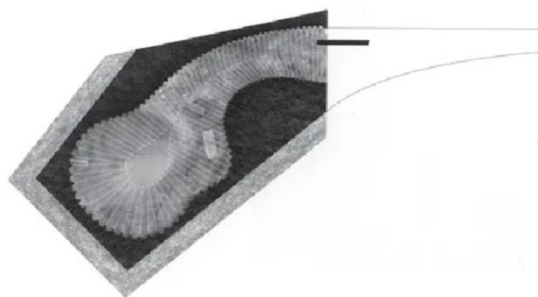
Capela Bruder Klaus. Planta Baixa. Wachendorf, Alemanha, 2007 – Peter Zumthor.
